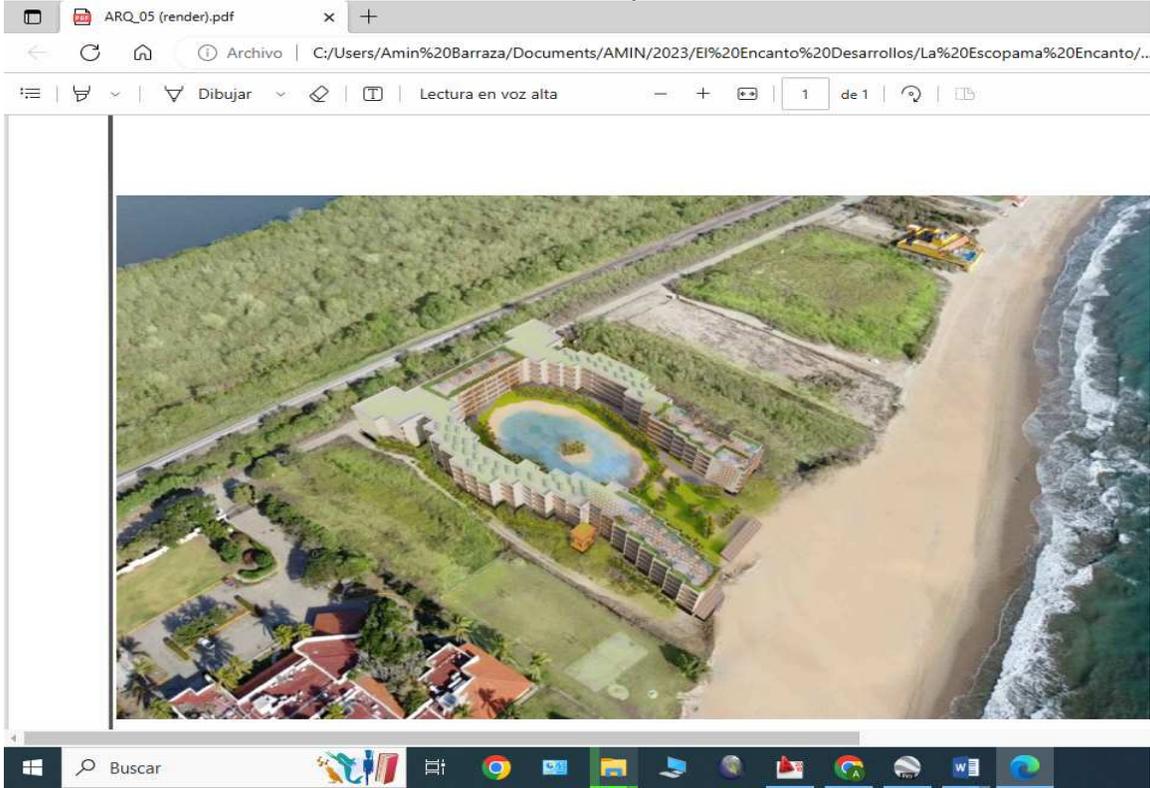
Render de la vista interior del proyecto. Ver Anexo 4. Plano Arq-05.
